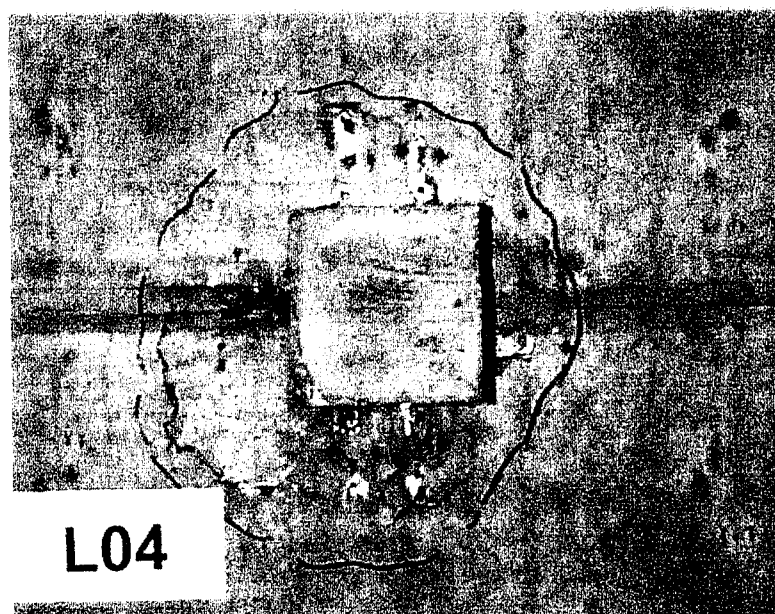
Vista inferior da Laje 04 (0% de fibras e com A_{sw})
